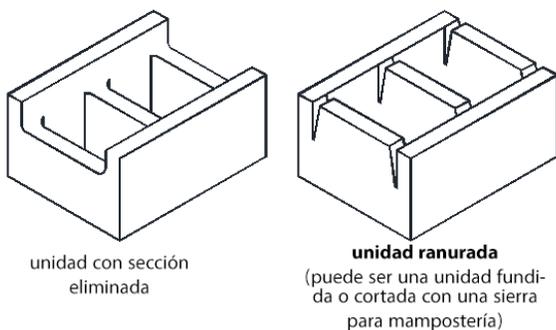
TIPOS DE BLOQUES DE VIGAS DE ENLACE
